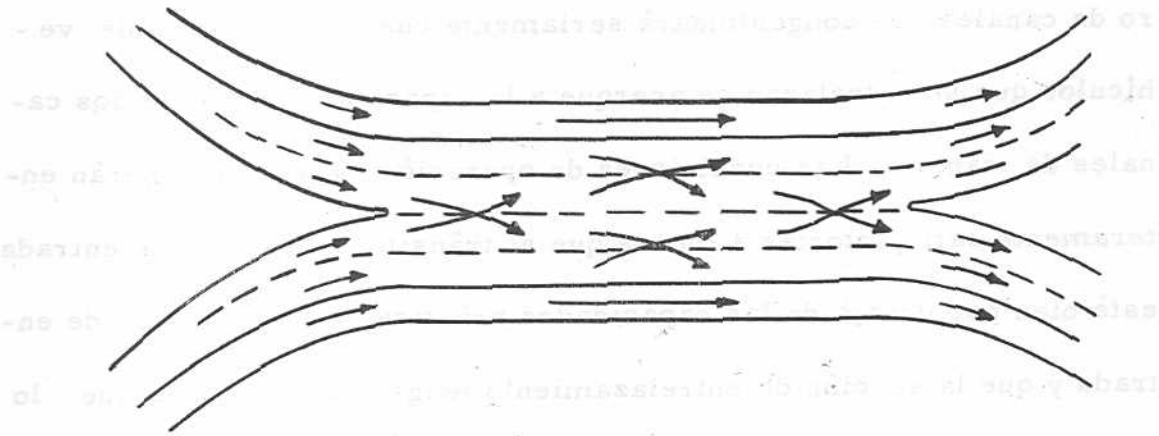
Una compleja sección de entrelazamiento.
